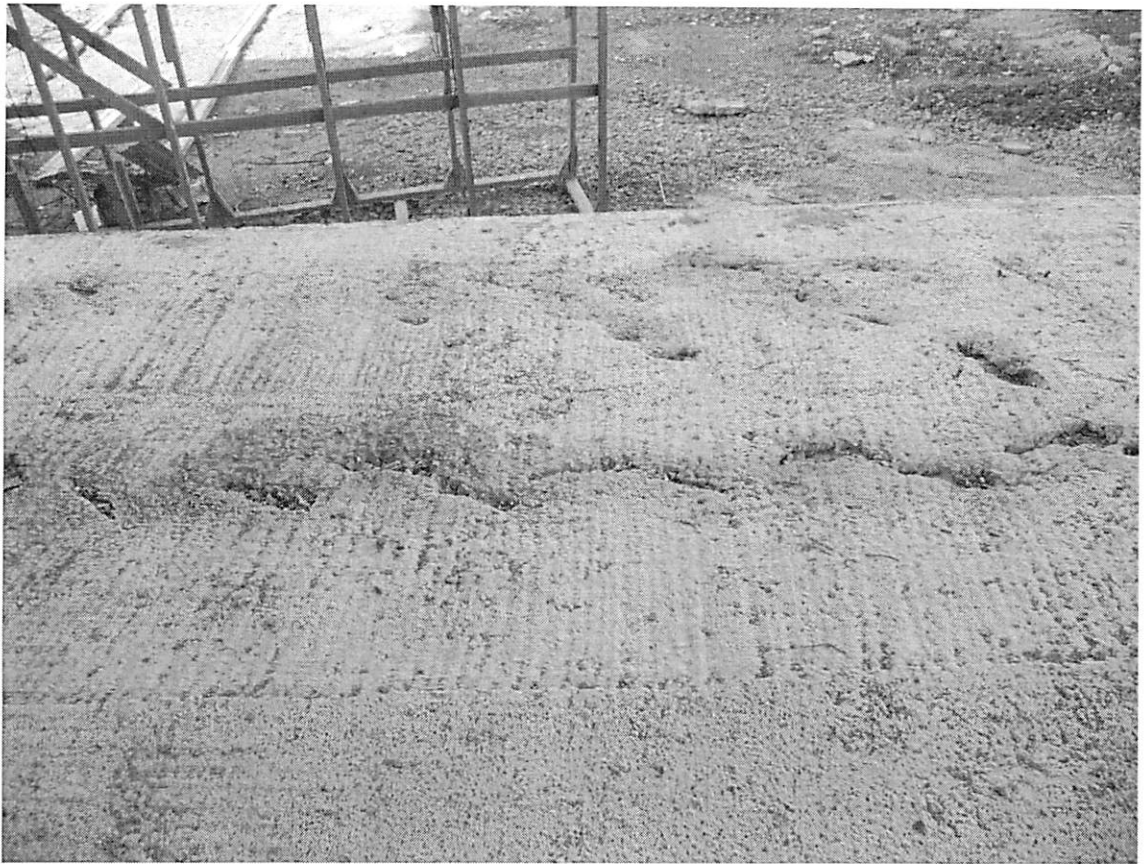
Участки непровибрированного бетона в плите перекрытия.
